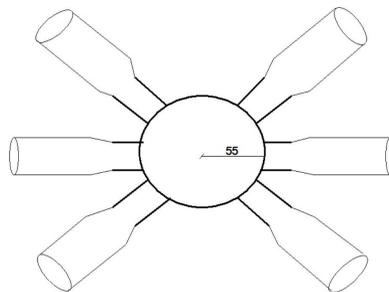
Vista superior da peça da cobertura com o tubo de ligação.
